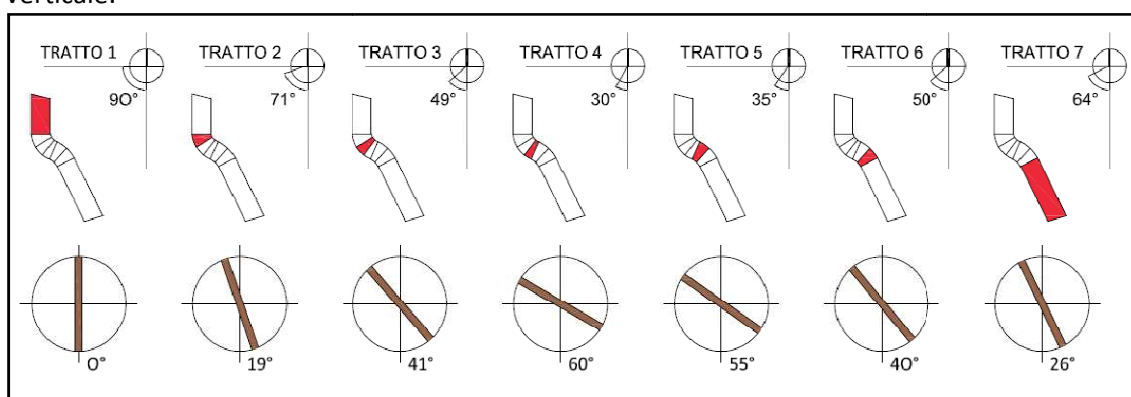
Suddivisione del prospetto in tratti e definizione dell'inclinazione dei listelli
